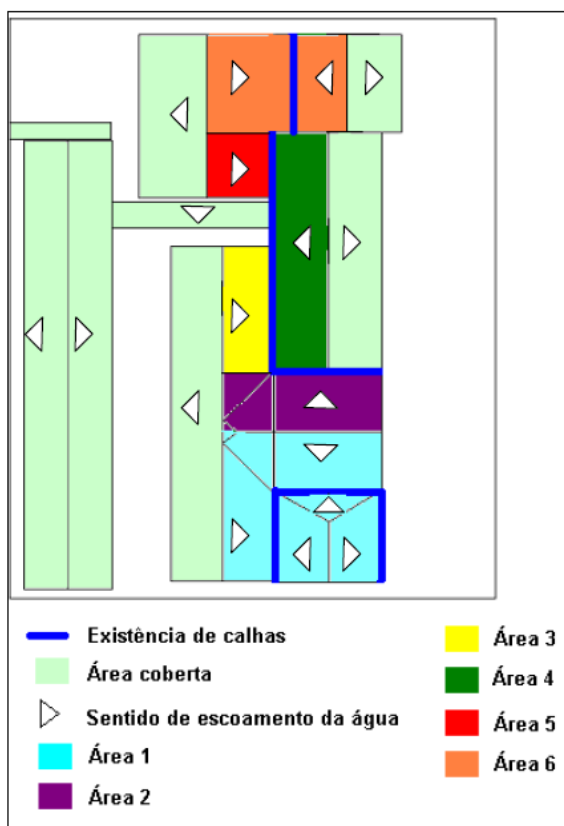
Subdivisões da Cobertura para o Cálculo Parcial.
